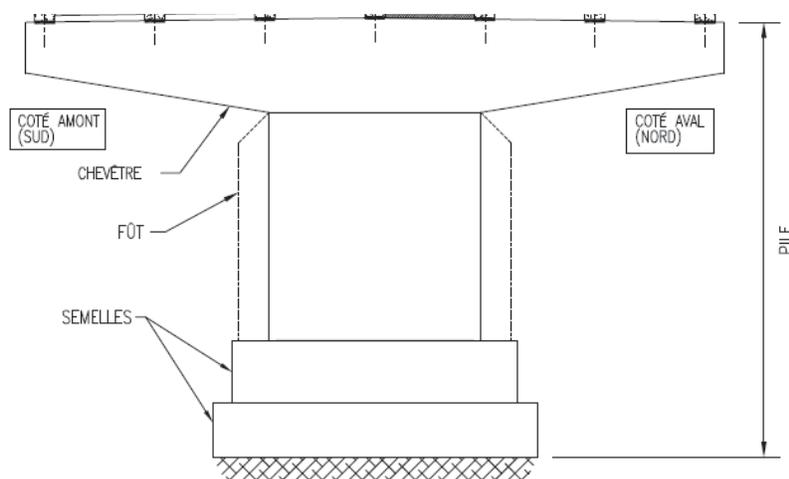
Piles – Section 7 (source : plans nomenclature PJCCI)
